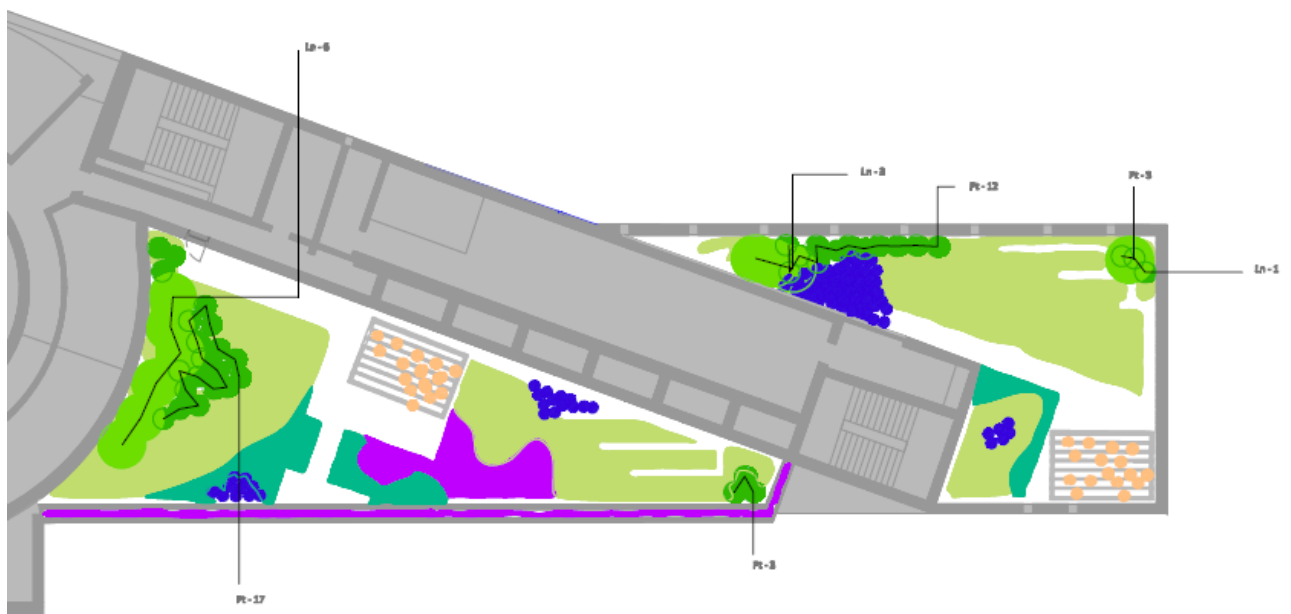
Proposta: Plano de Plantação (ver anexo B)
